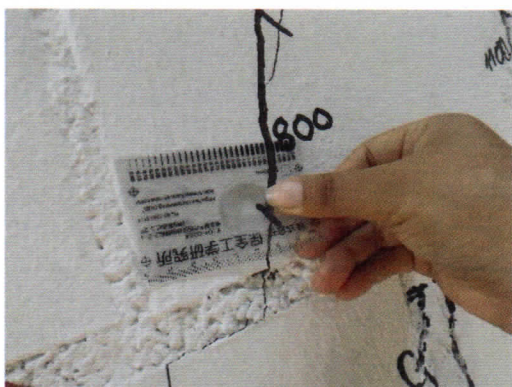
Espesor de grieta de 1.60mm en ladrillo de la cara Norte para una distorsión de 1/400.
